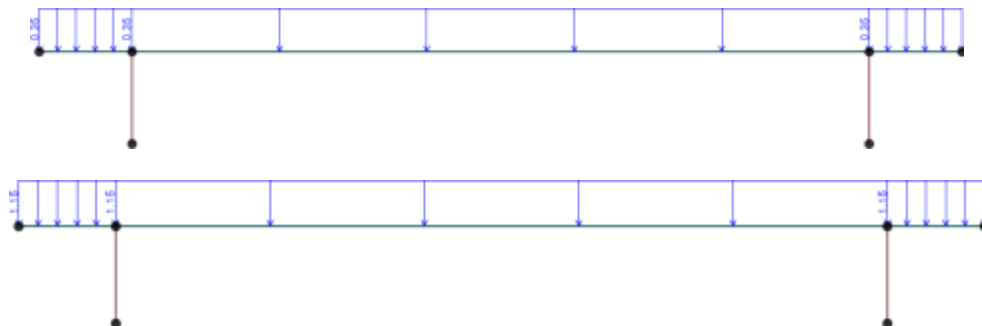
Cargas muertas y vivas aplicadas en la estructura. Fuente: Elaboración propia.
